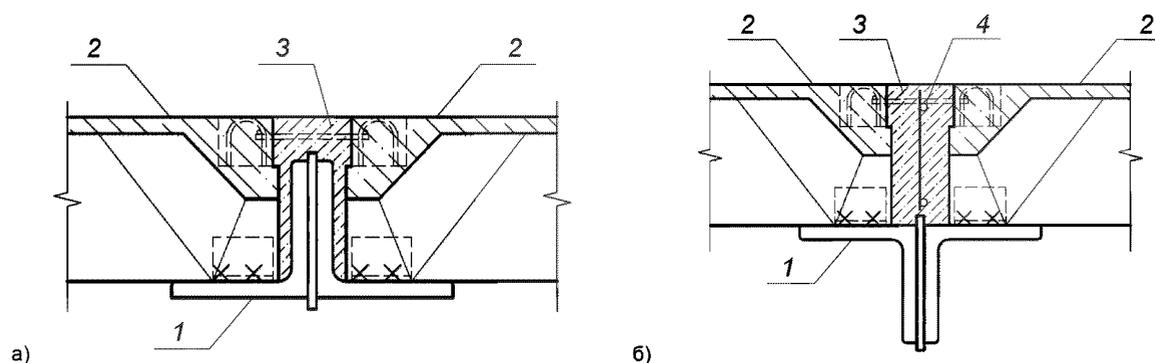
Схема узла сопряжения монолитного перекрытия по профилированному настилу с поясами ферм
